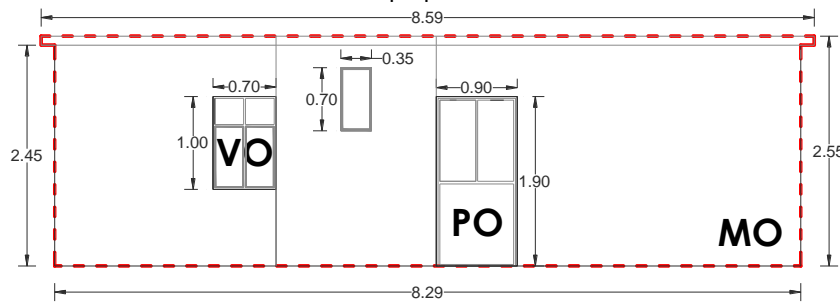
Fachada Oeste – F3. Fuente: Elaboración propia.
